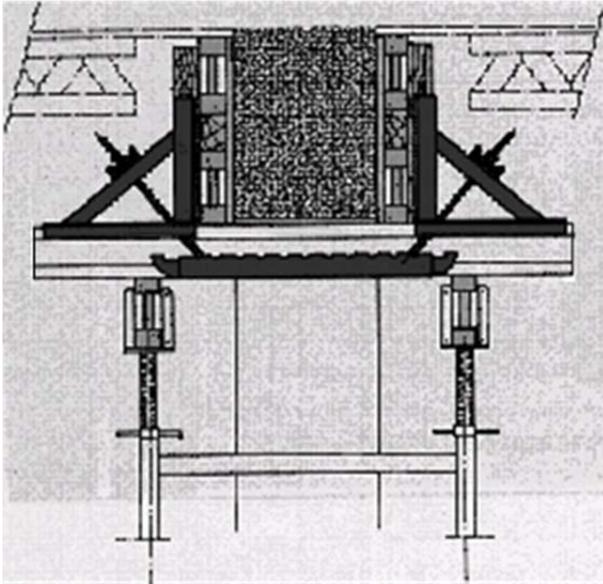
Aufbau einer Schalung für Unterzüge [7]
